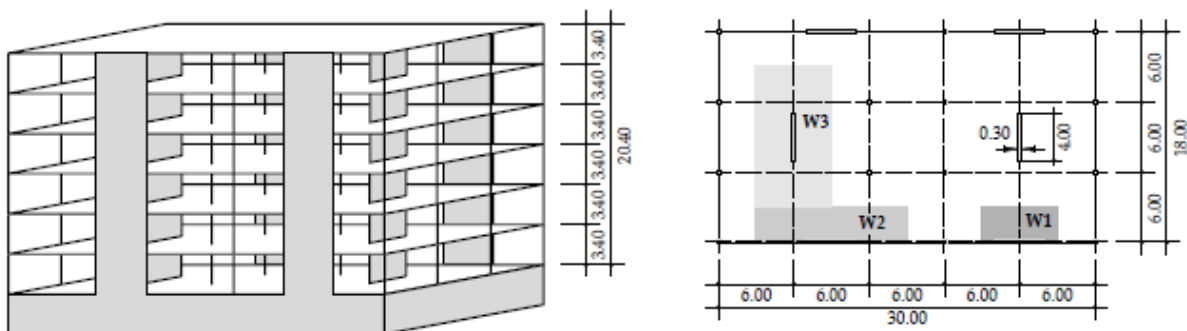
Bâtiment de référence : élévation (à gauche), coupe transversale d'un plancher (à droite).
